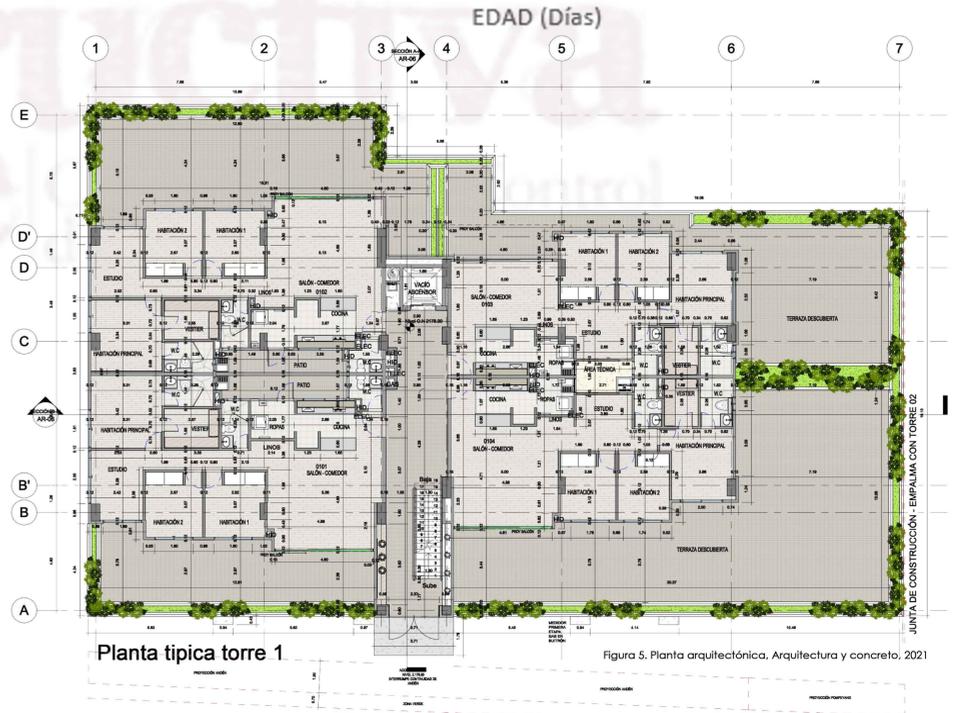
Planta arquitectónica, Arquitectura y concreto, 2021
